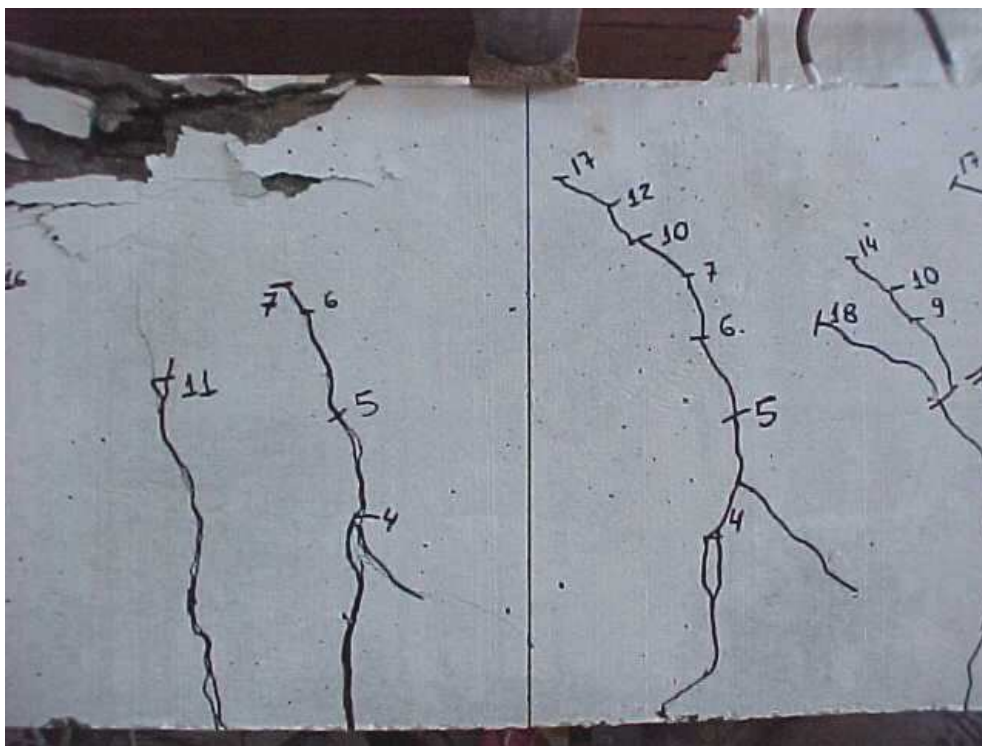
Detalhe do ponto de aplicação de carga na região central da viga
